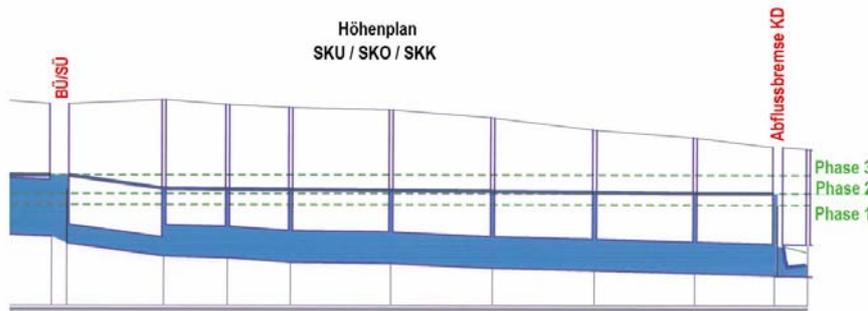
Höhenplan mit Darstellung des zu 100 % aktivierten Rückhaltevolumens
